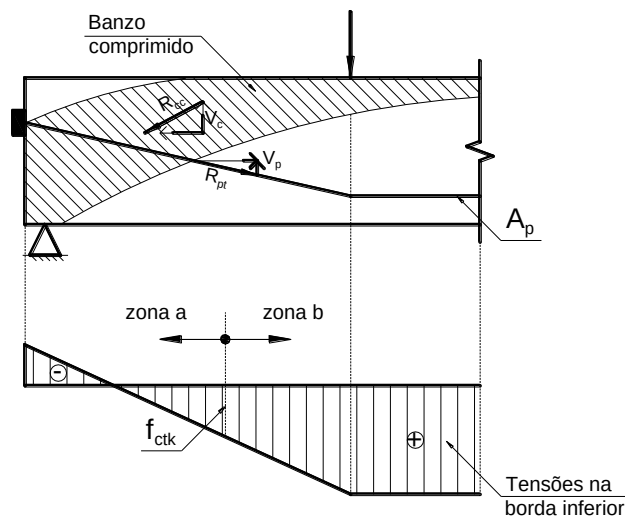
Zona b com fissuração e zona a sem fissuração.
